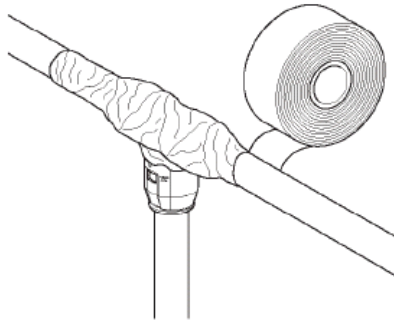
Pose du bandage sur l'assemblage à emboîter PushFit
